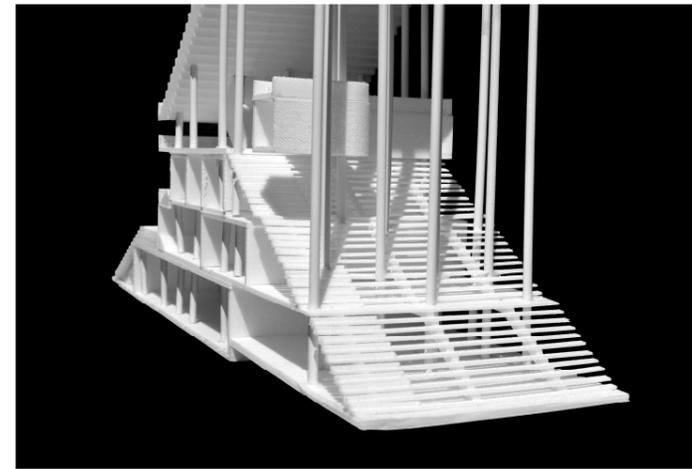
Foto detalle de maqueta de las escaleras principales de acceso.
